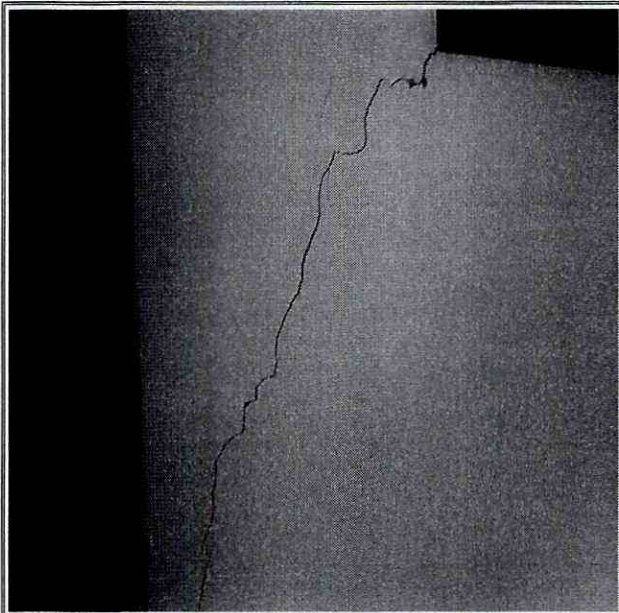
Grietas muro divisorio segundo nivel de la vivienda
